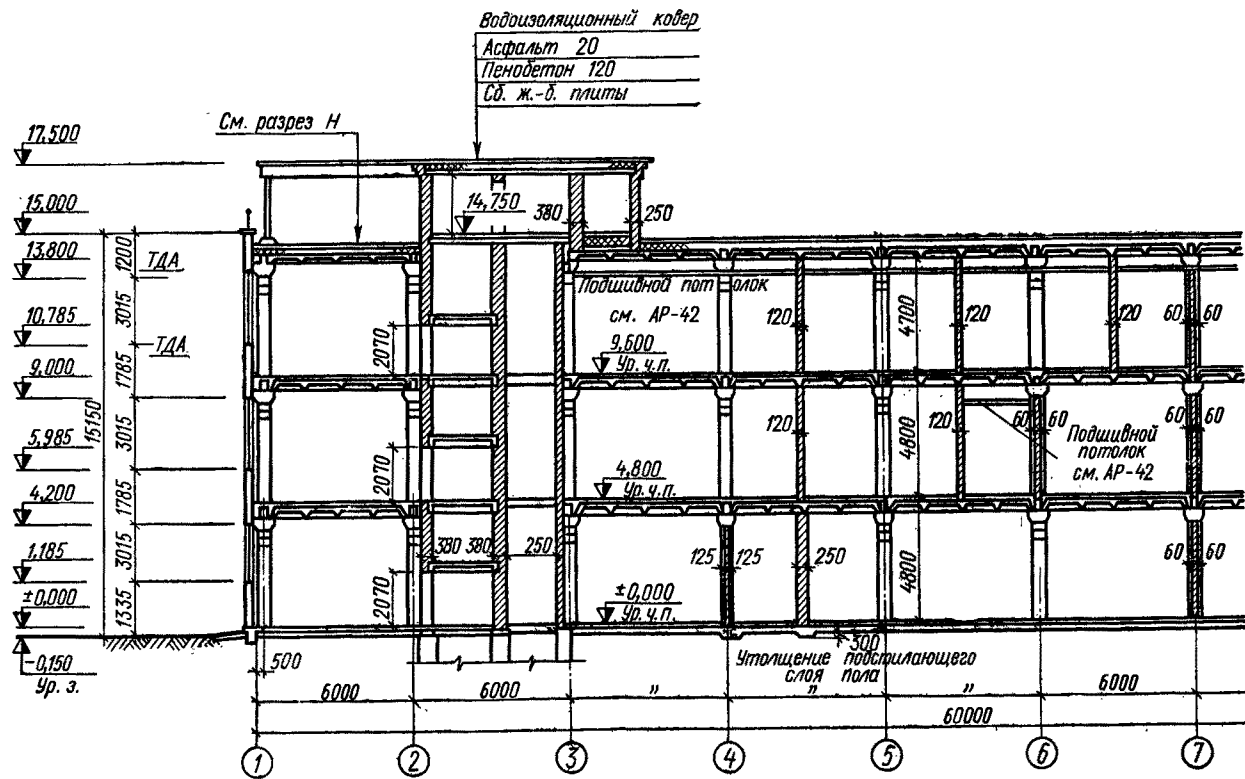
Пример графического оформления продольного разреза многоэтажного промышленного здания со сборными железобетонными конструкциями
